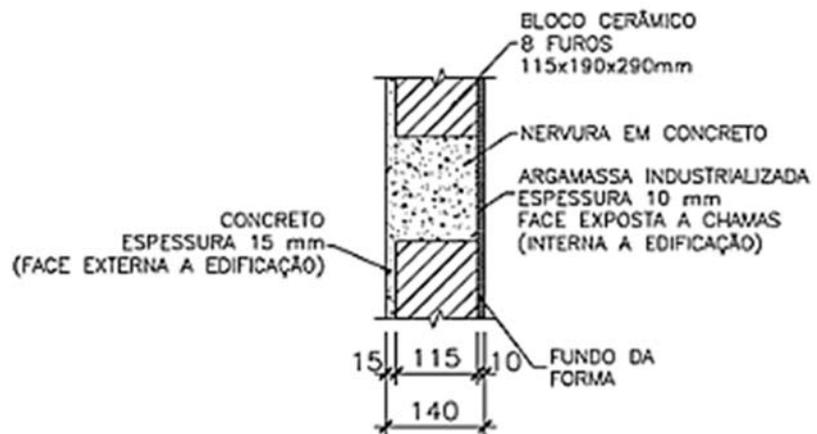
Corte típico do painel das paredes de geminação e de divisa de áreas comuns (medidas em mm)
